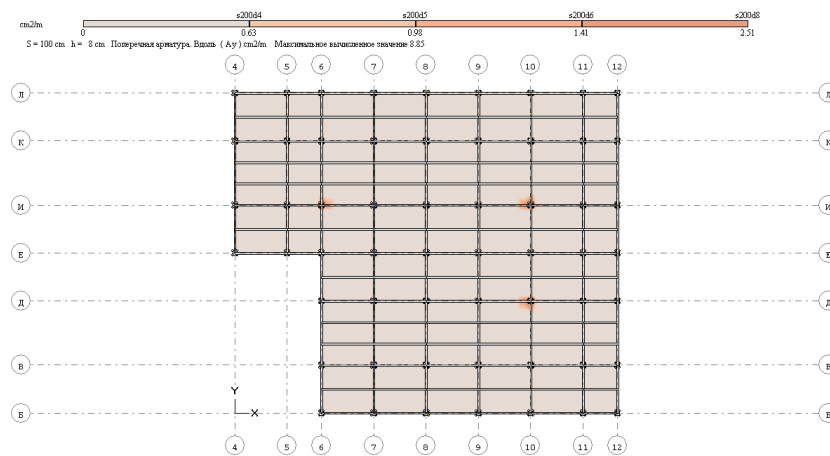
Поперечна арматура вздовж осі Y
